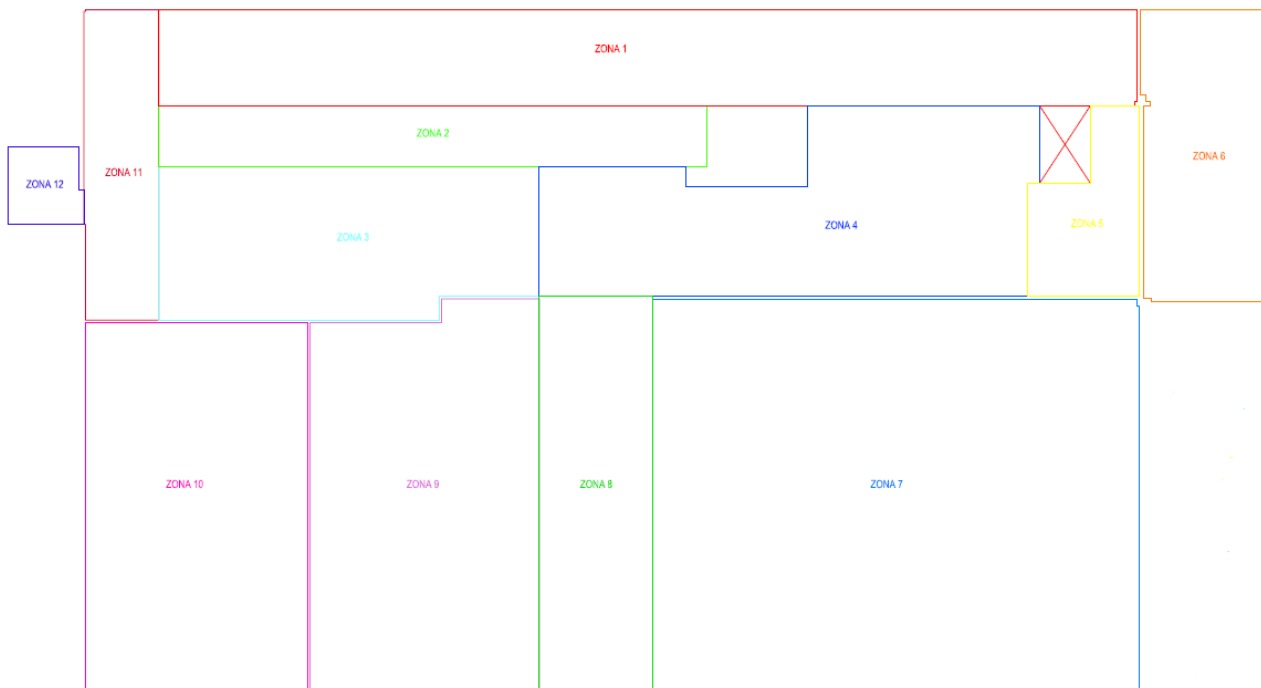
Planta do armazém e oficinas (piso 0).
